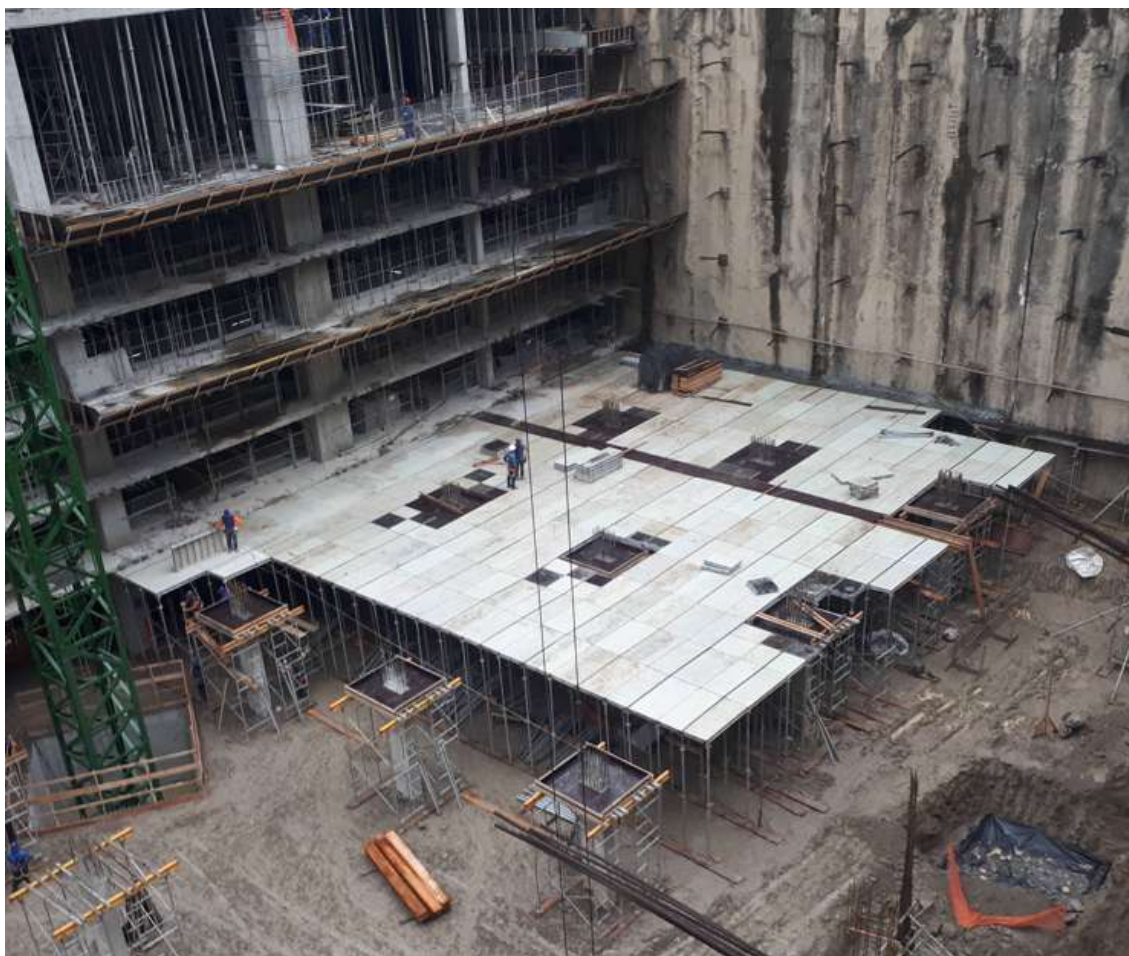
Obra Edifício Birmann - B32 - São Paulo
